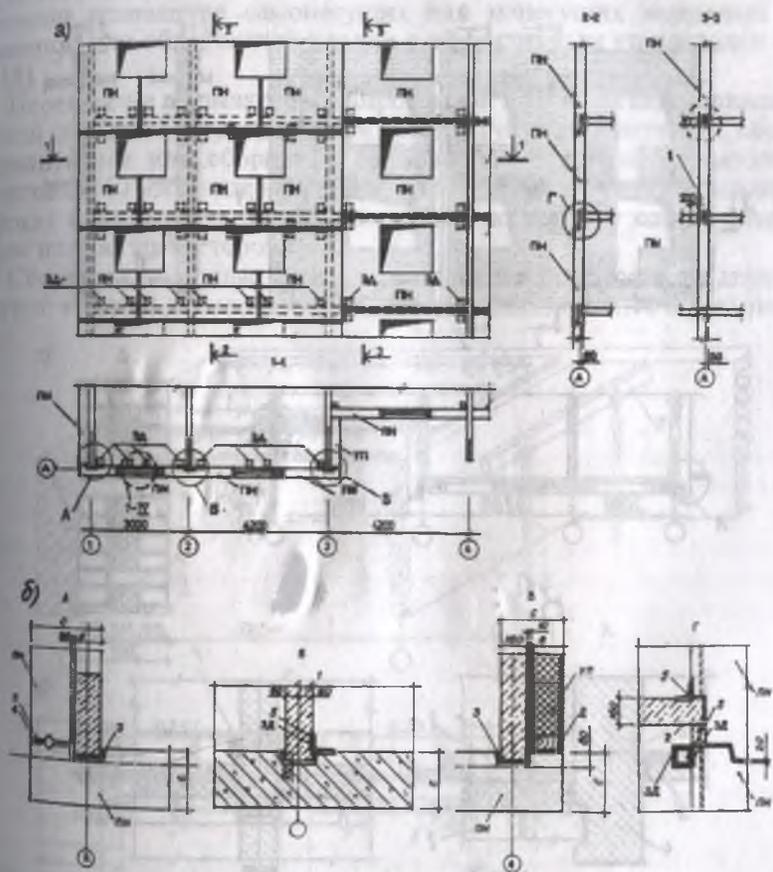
Панельные наружные стены зданий с монолитными внутренними стенами и перекрытиями:
